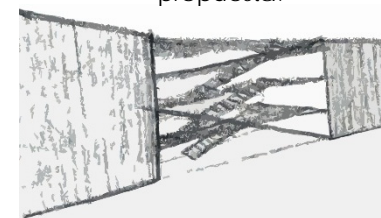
Croquis de la escalera de la vivienda de la segunda propuesta.
